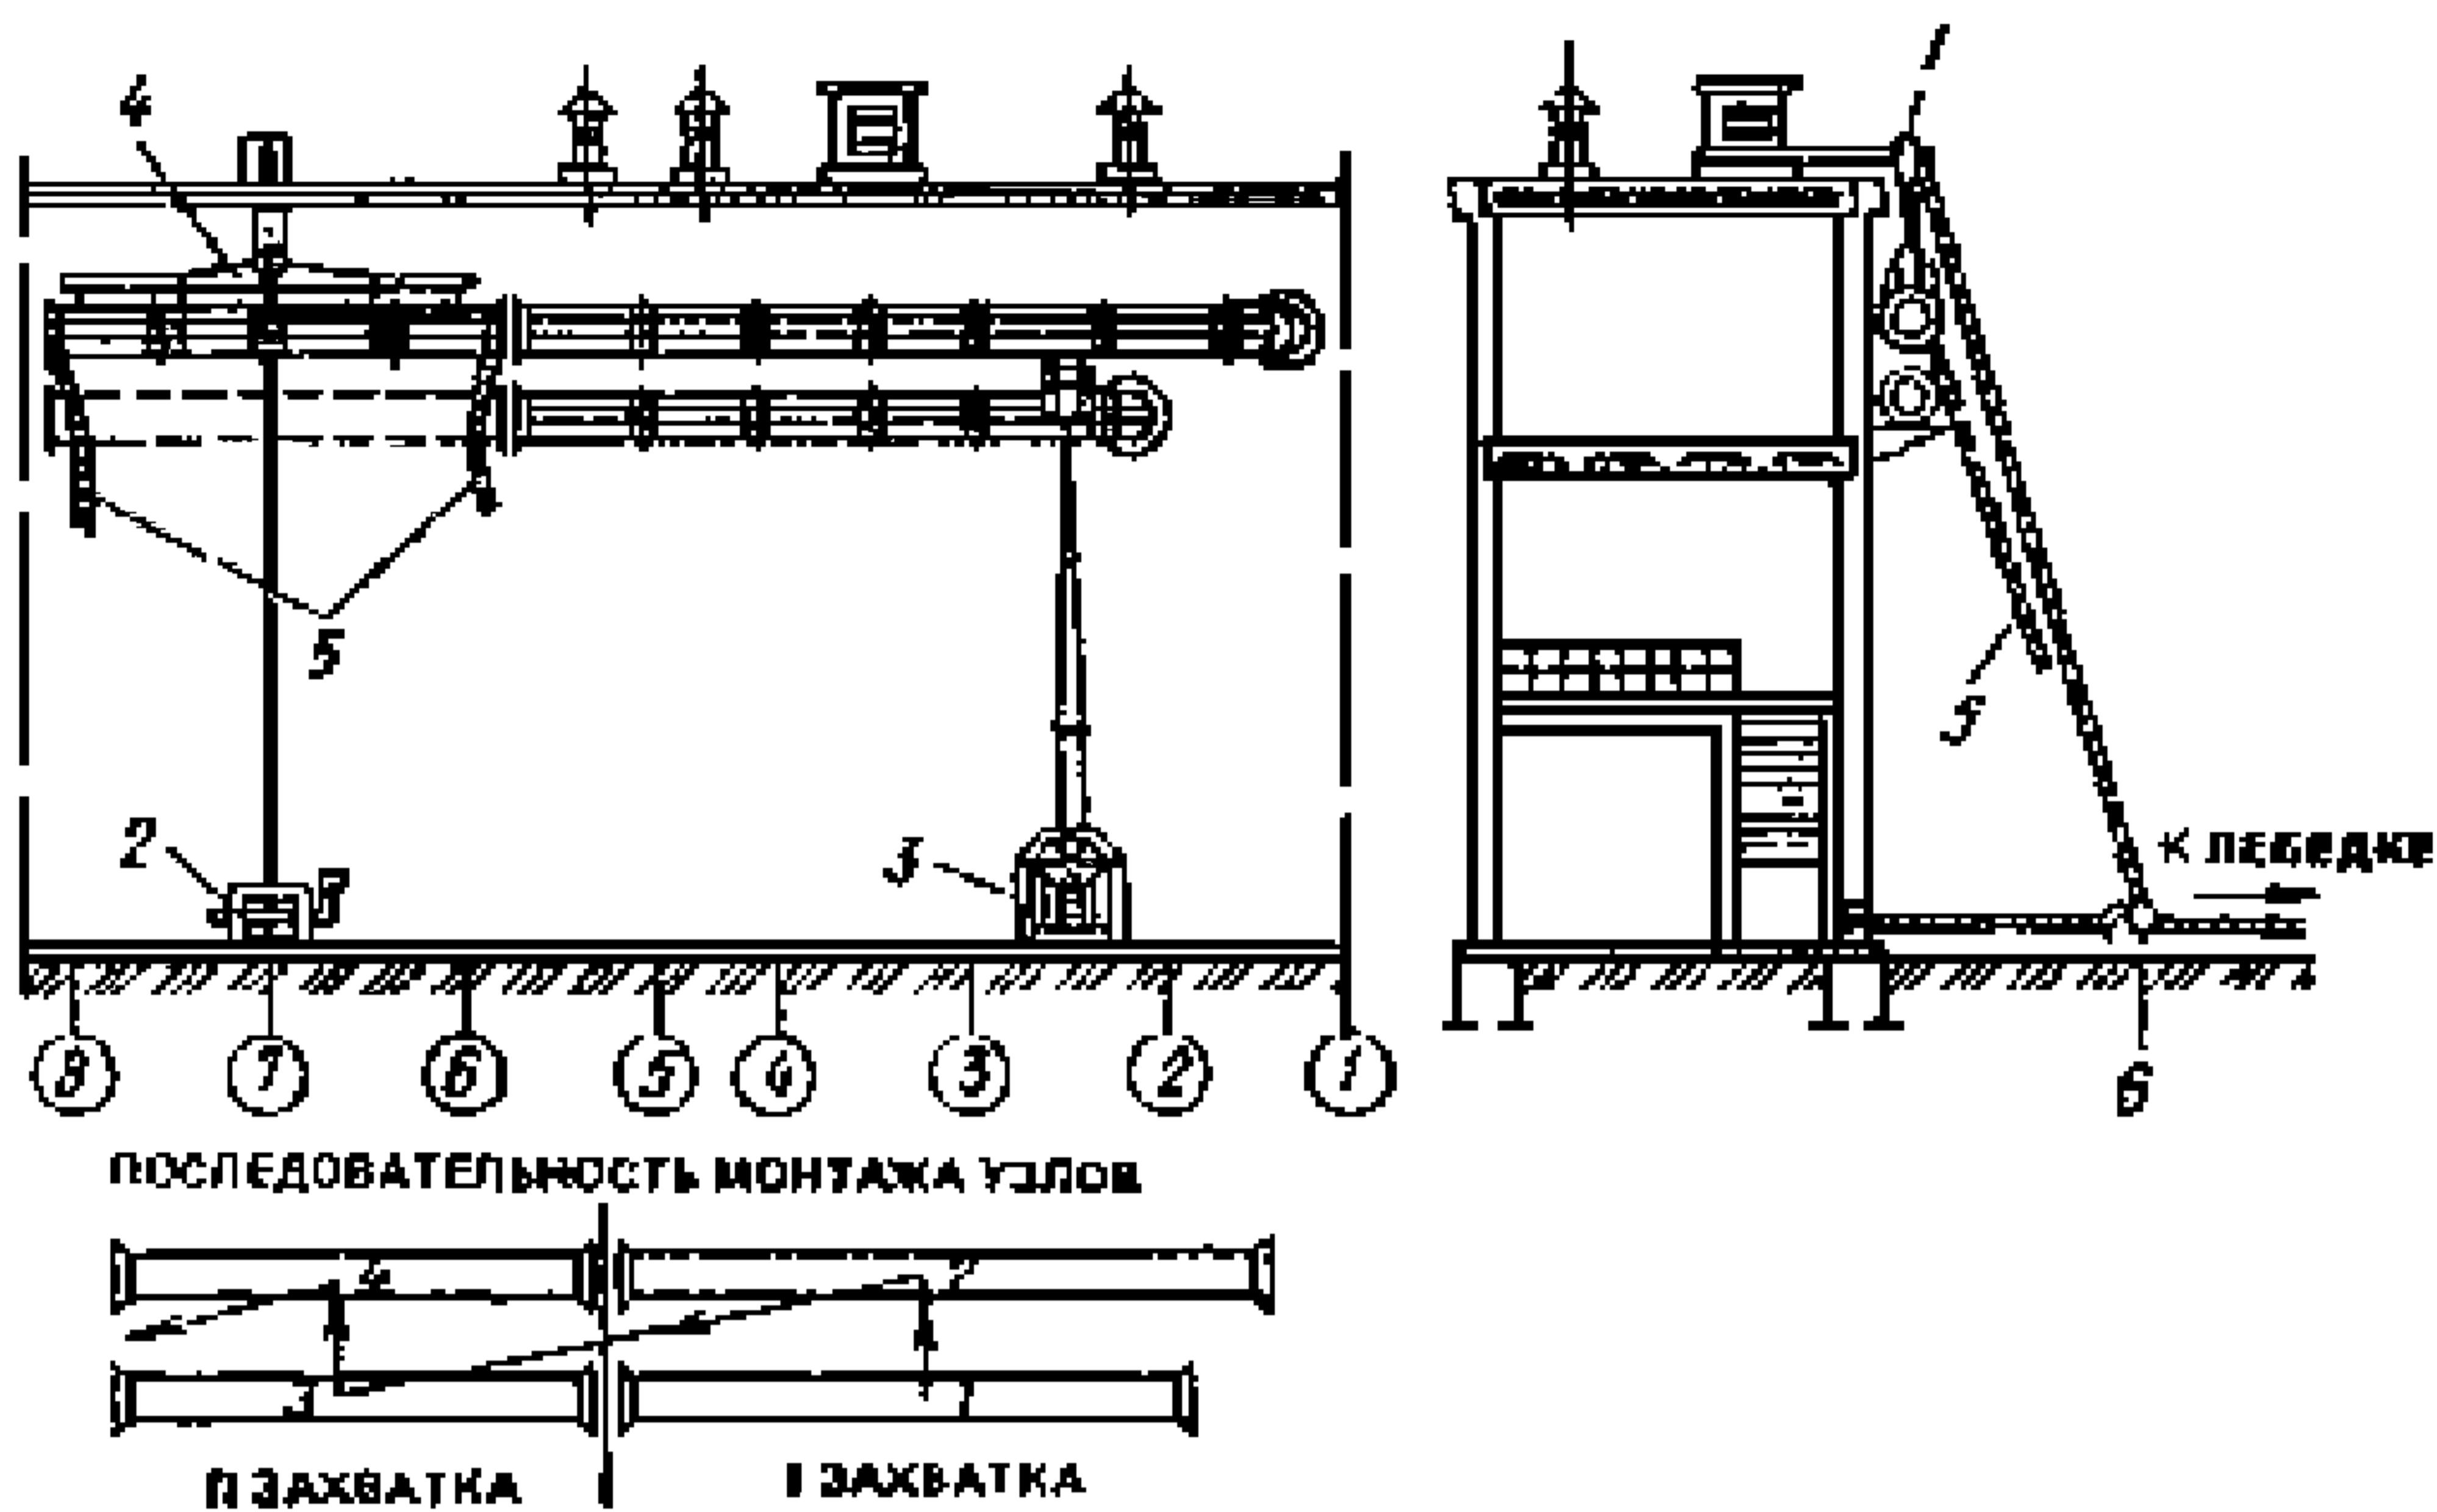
Схема организации рабочей зоны при монтаже воздуховодов по наружной стене здания
